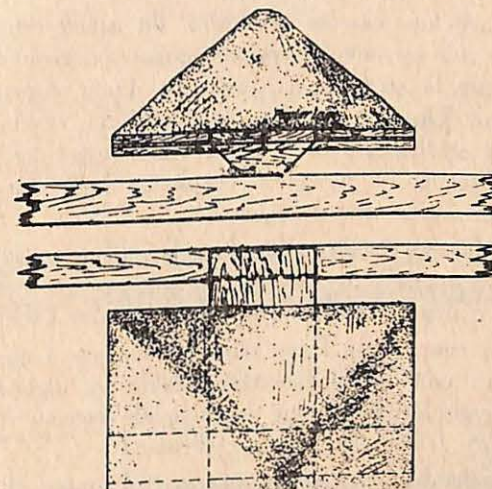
Plateforme Dortmund basculant autour d'une planche centrale.
